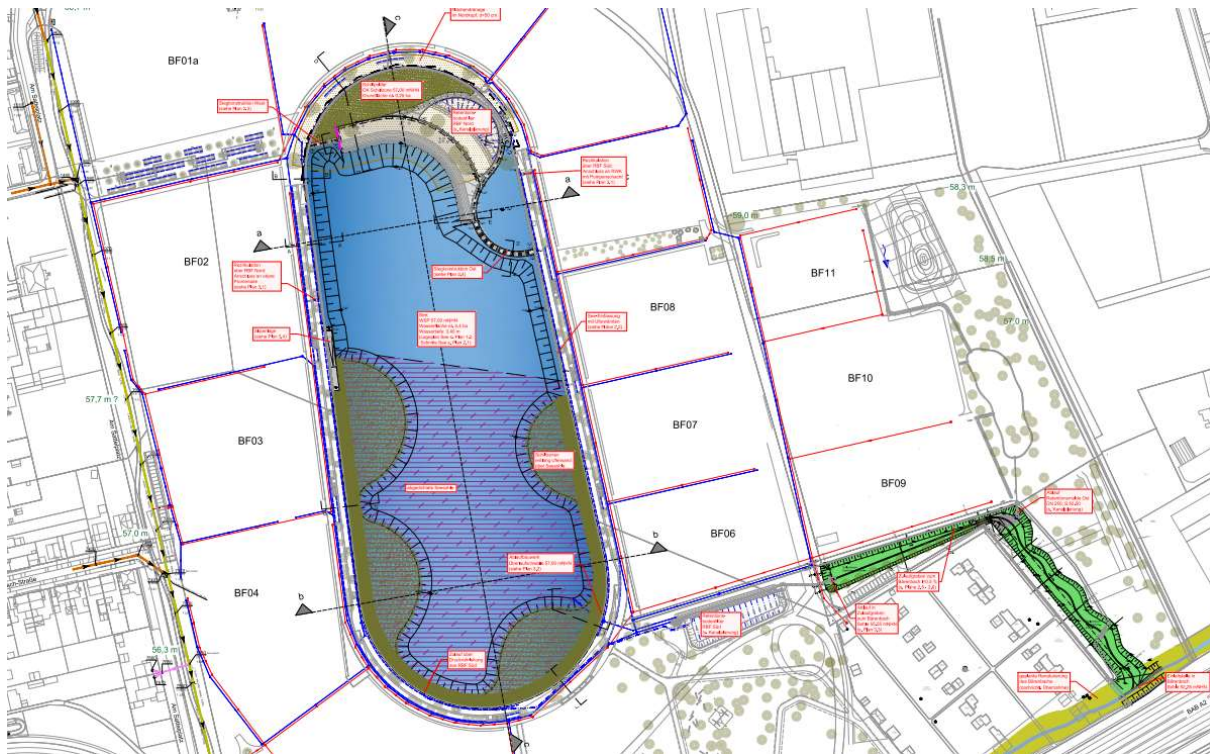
Gesamtlageplan [Plan B-1.1 Seeplanung]
